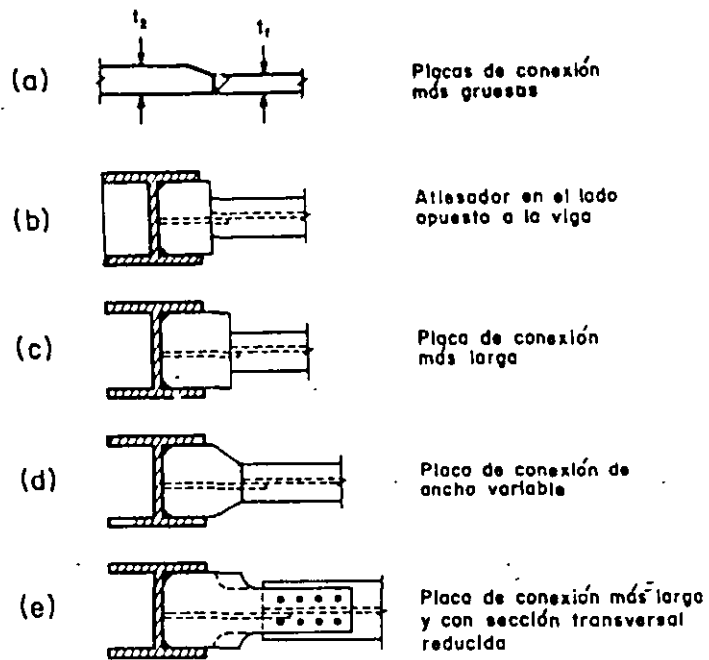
Medidas para mejorar el comportamiento de juntas con vigas unidas al alma de la columna.
